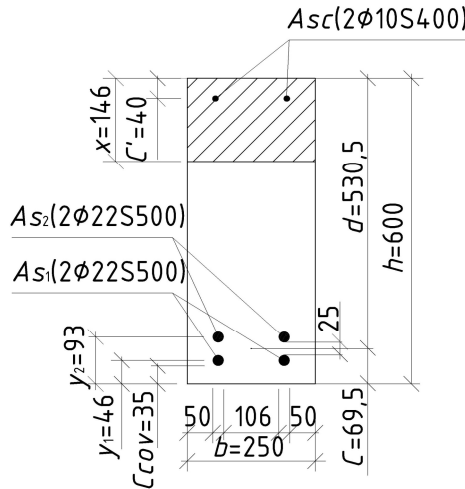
Расчетное нормальное к продольной оси (поперечное) сечение балки
